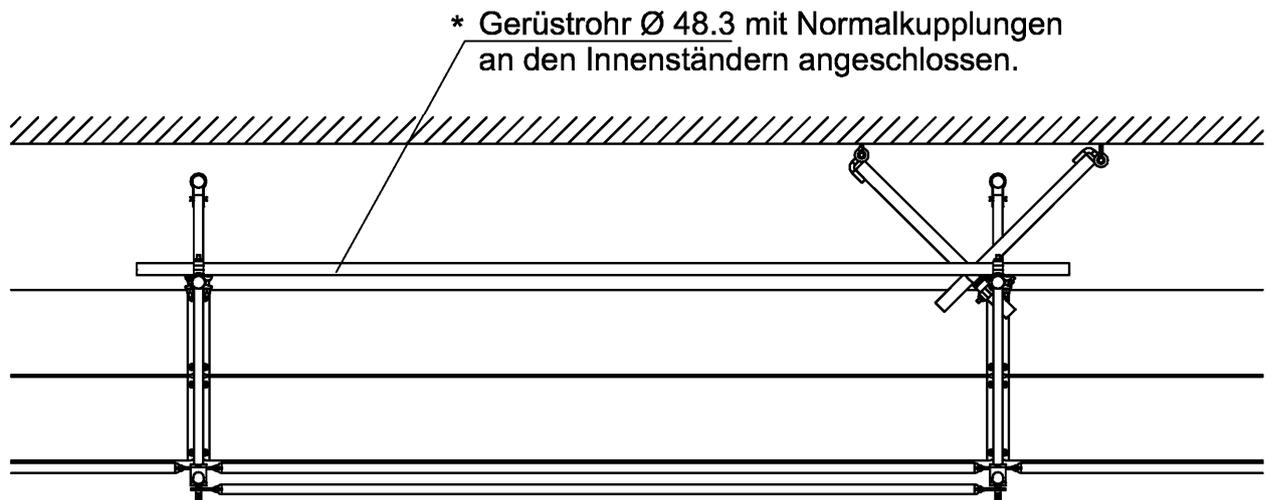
Dreieckhalter mit Gerüstrohraussteifung
